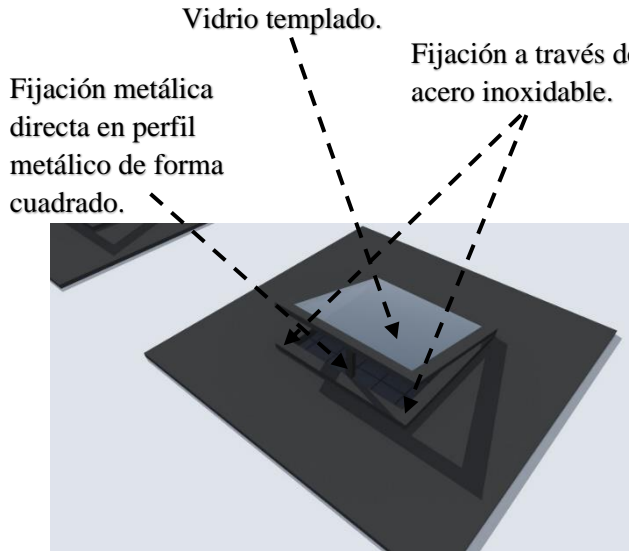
Vista en planta Uso de claraboyas. Fuente: Elaboración Propia
